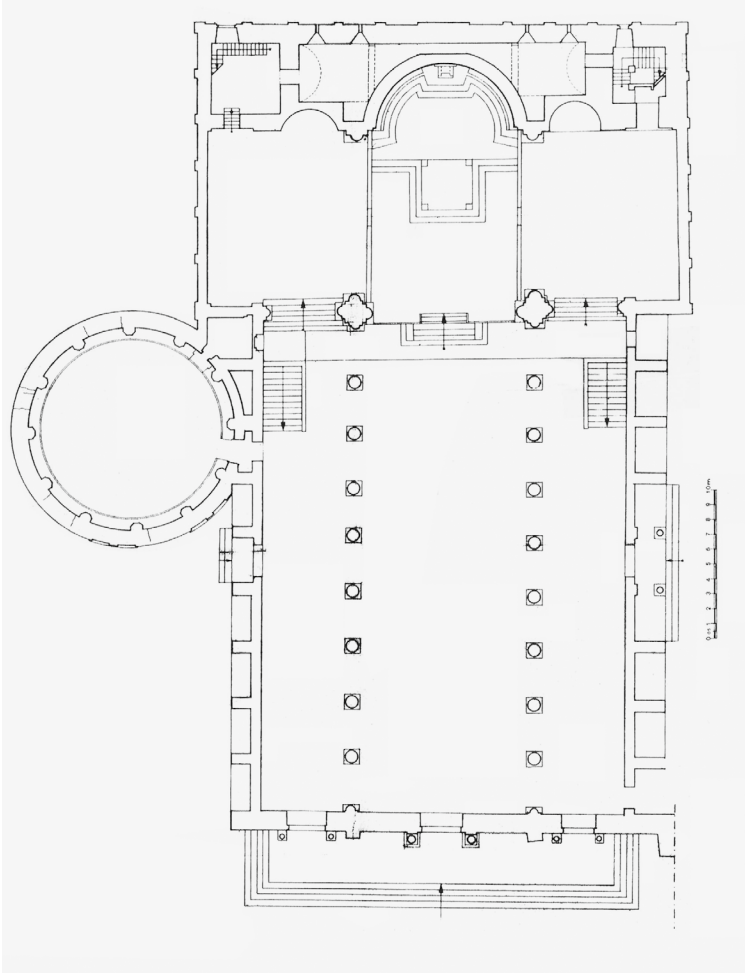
| Grundriss der Oberkirche der Kathedrale San Sabino, Bari, 1:300 (KAPPEL, San Nicola, Abb. 112).
